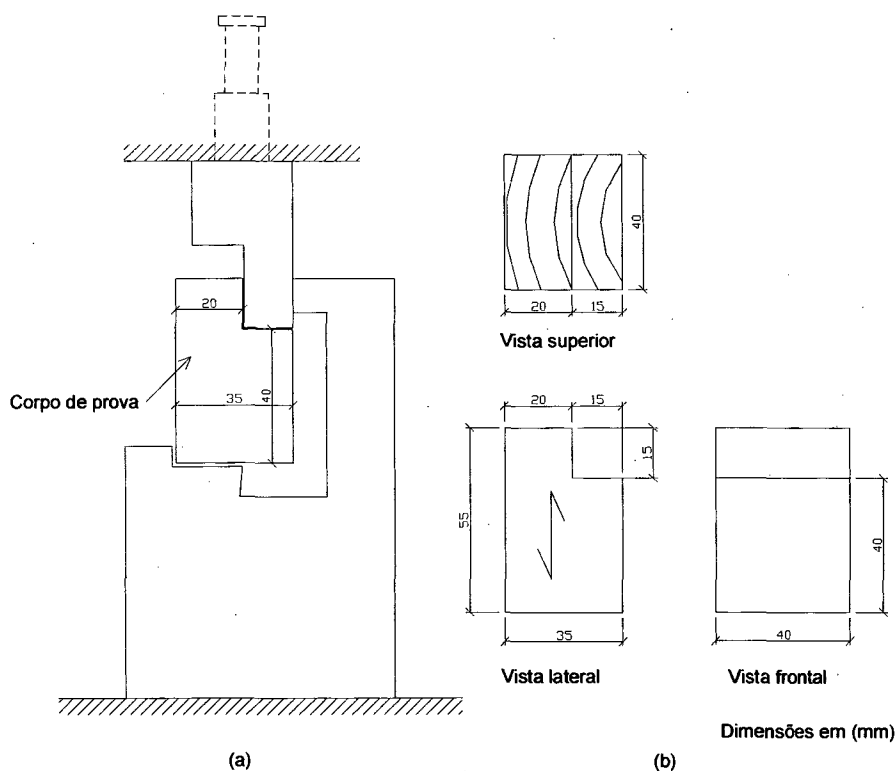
(a) Dispositivo de ensaio e (b) corpo-de-prova para ensaio de cisalhamento paralelo às fibras da madeira.
